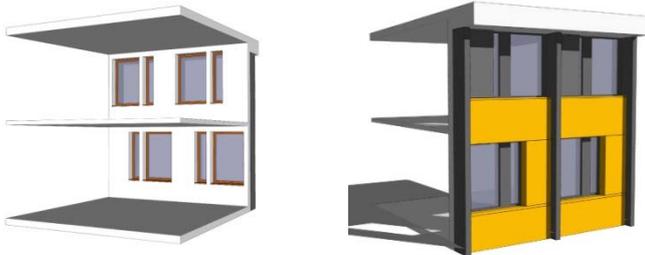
Fassadenausschnitt Verwaltung von innen und außen
